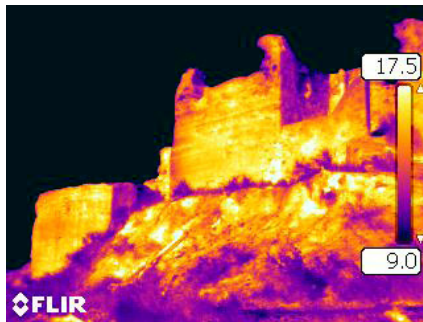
y 19. Fachada Sureste. No se aprecian discontinuidades térmicas importantes en las fachadas o laterales de las torres. En la torre central se detecta un hueco visible a simple vista que no atraviesa el muro, lo que puede ser producto de la degradación o por acción de los seres vivos. En la torre de esquina, a la izquierda, se aprecia una pequeña discontinuidad en su cara lateral, identificada con el cambio de materialidad que se aprecia a simple vista.
